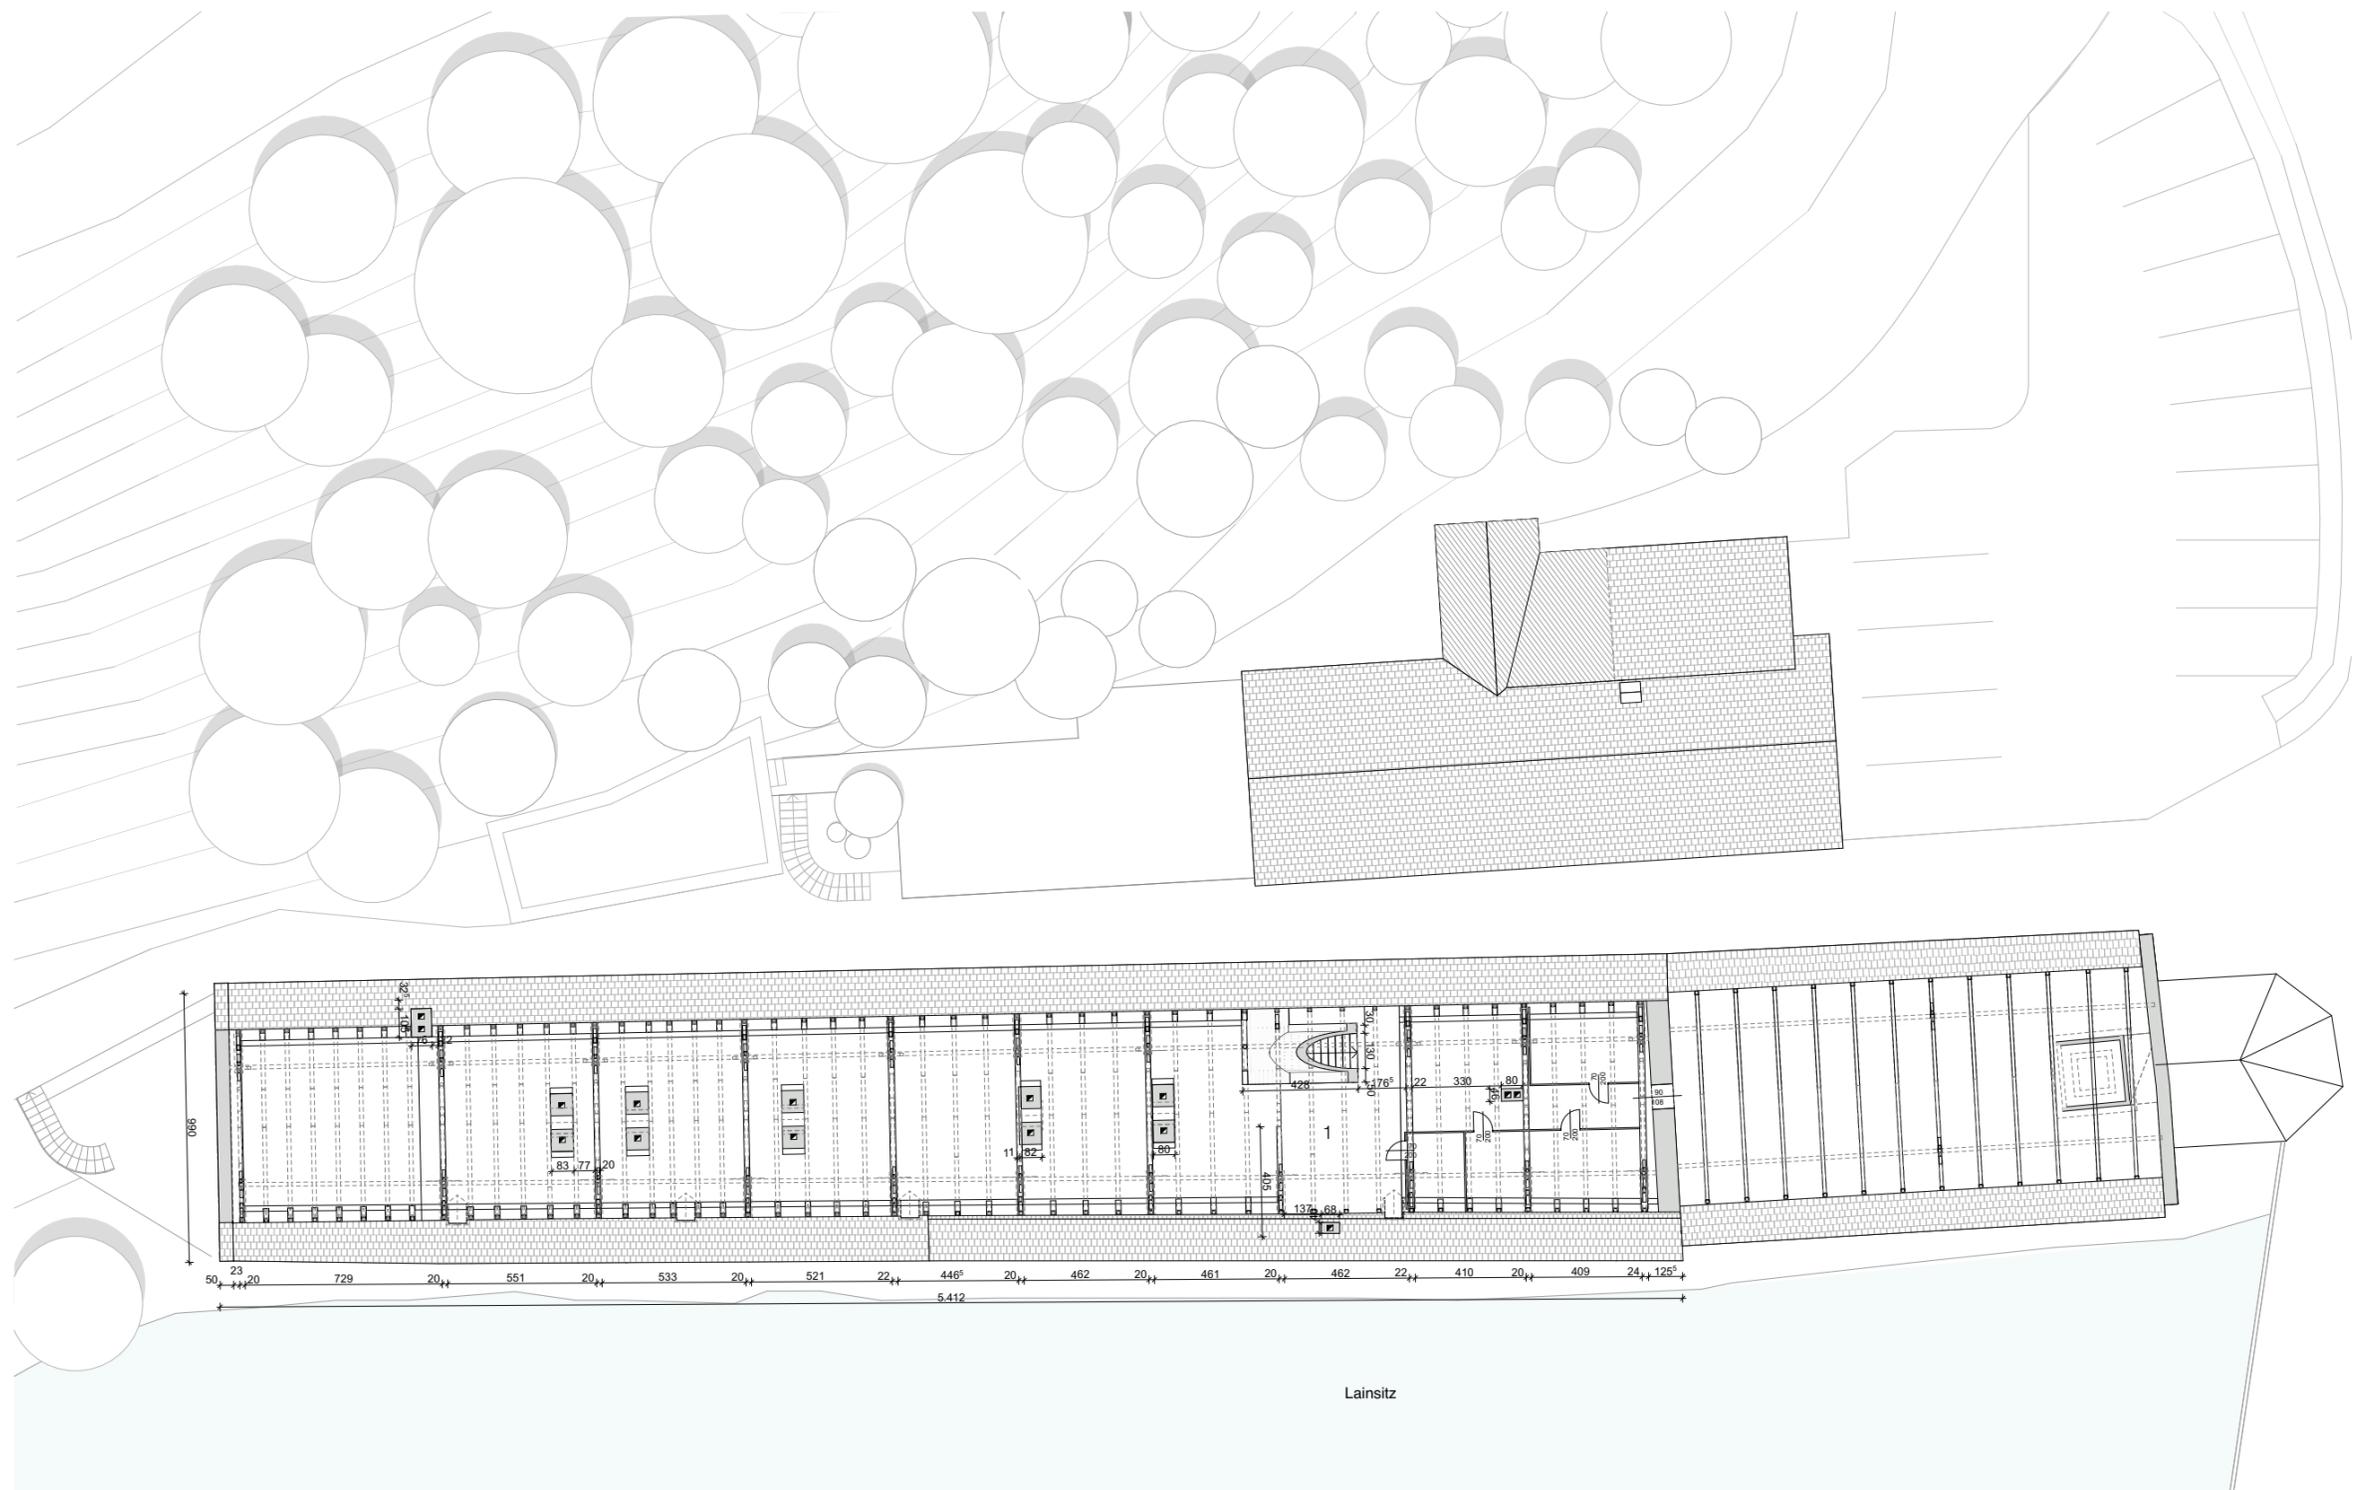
Bestandsplan. Obergeschoss Spitalstrakt und Spitalkirche, Dachboden Wirtschaftstrakt
